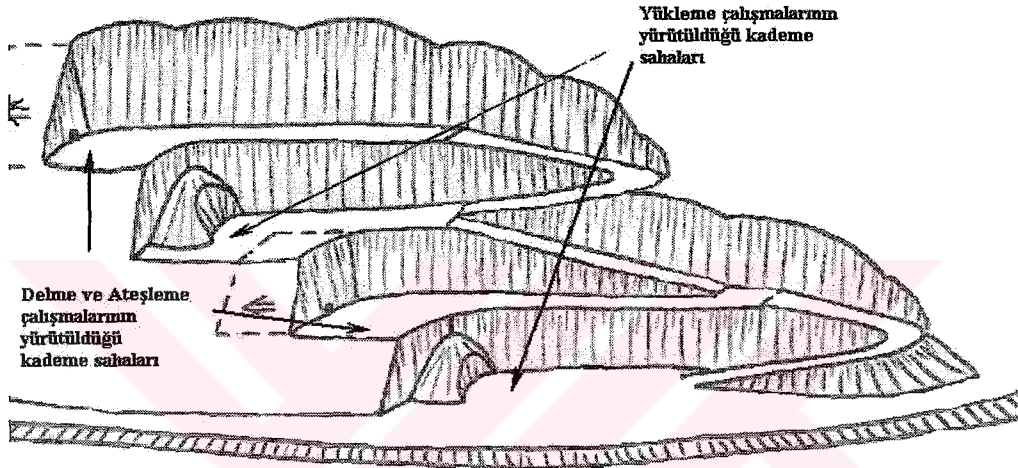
İdeal kademeli çalışma şekli ve kademelerdeki çalışma planı (Güney, 2000).
